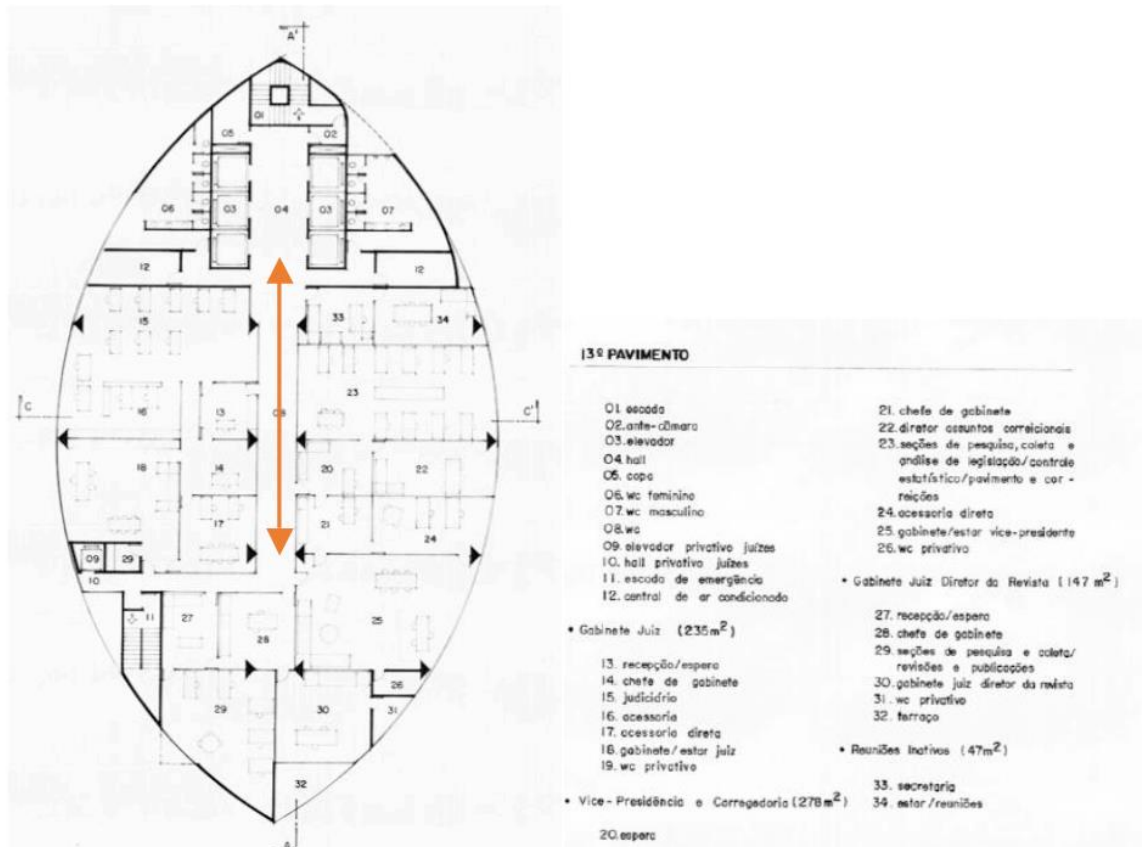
Planta Baixa – 13º Pavimento. Fonte: Carolina Mapurunga, 2016.
